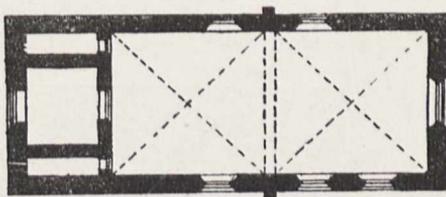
Gramzow; Kirche, Grundriss.
